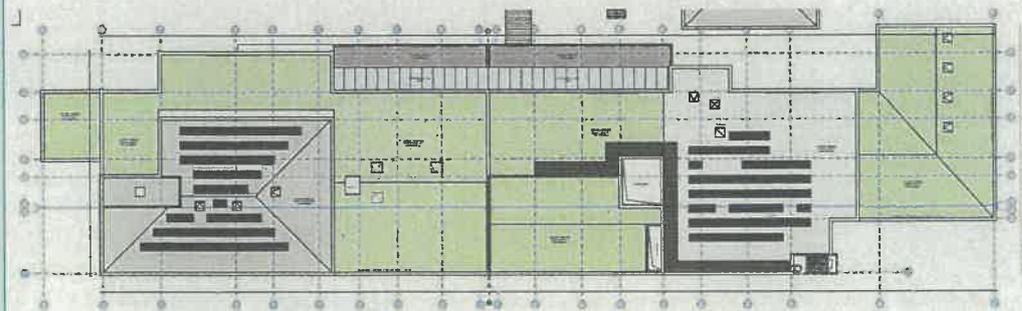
Plan de l'emplacement des panneaux photovoltaïques sur les toitures en gravillon du nouveau bâtiment (plan en phase PC, 28/04/23)
